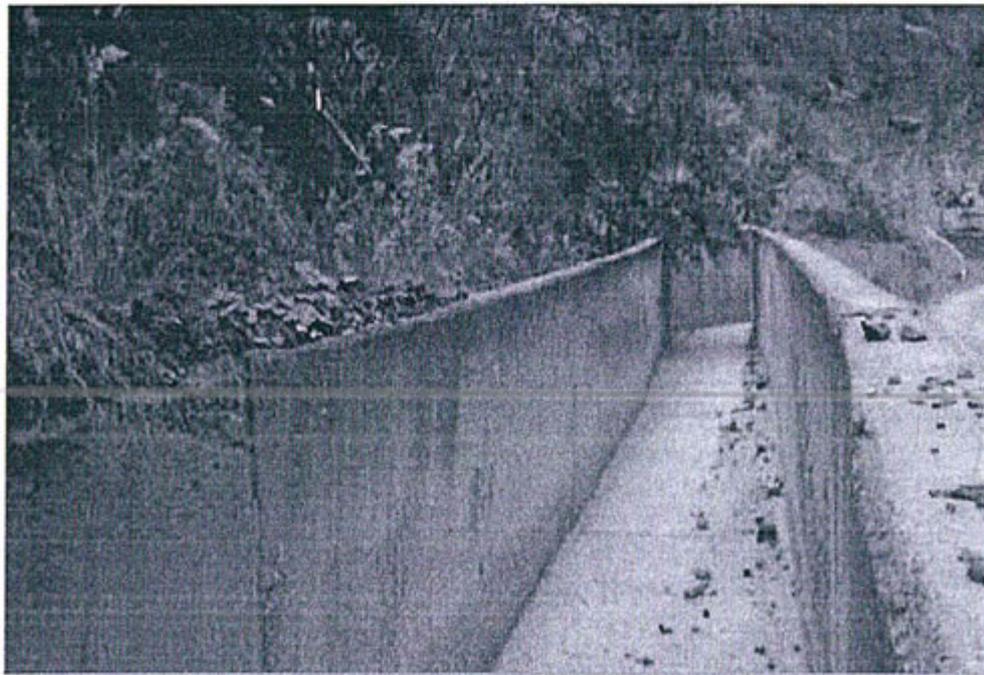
Estado del concreto armado de las estructuras hidráulicas del canal de derivación de concreto armado (tomada en junio de 2015)
